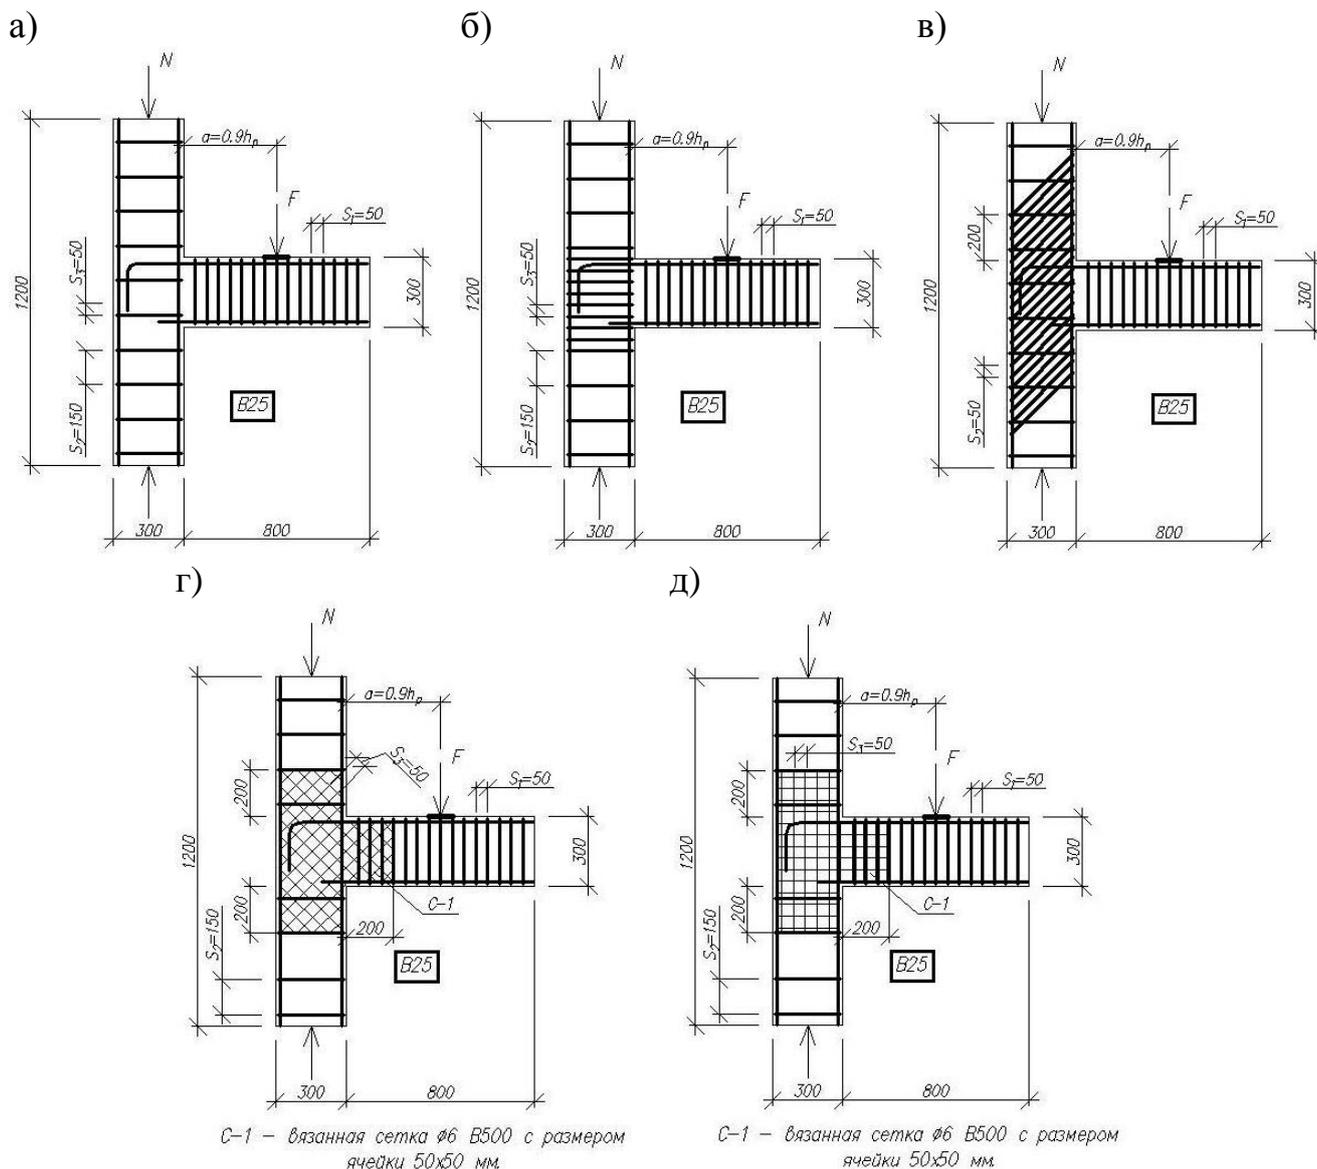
Программа экспериментальных исследований центральной части монолитных железобетонных узлов сопряжения колонн крайнего ряда с балками при изменении схем армирования
